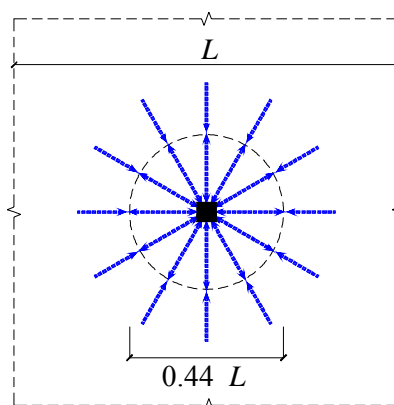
Effet de confinement dans un plancher-dalle, vue en plan
